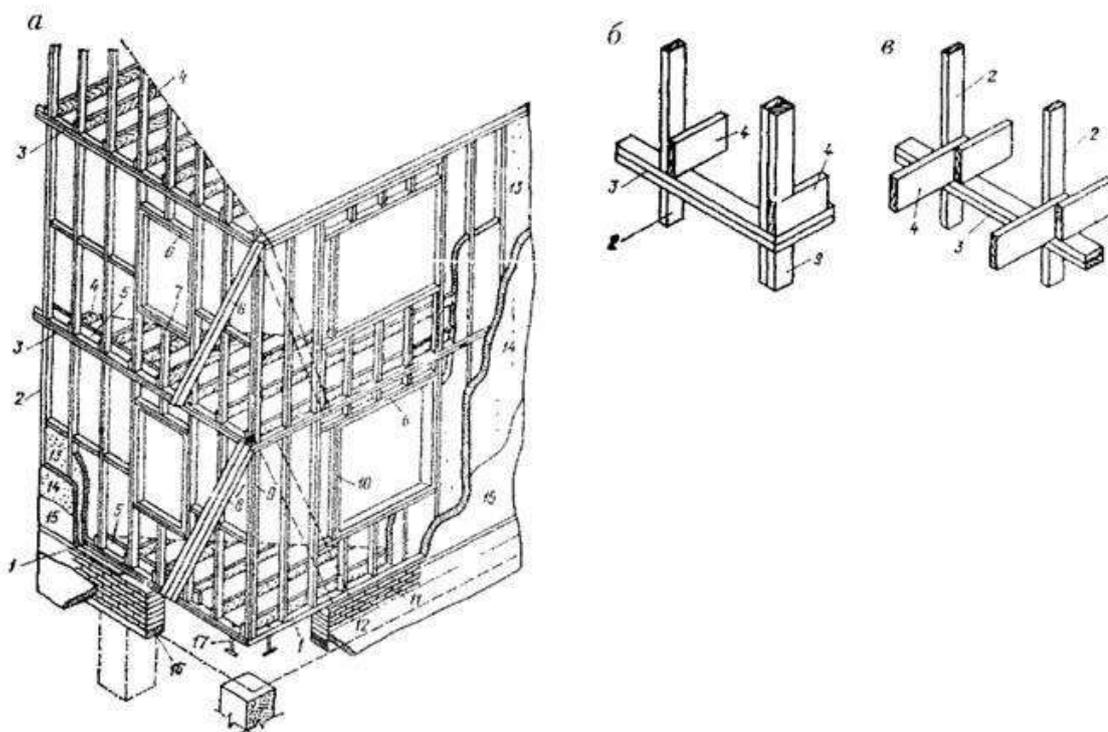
Конструкции каркасного здания с контактным сопряжением стоек
